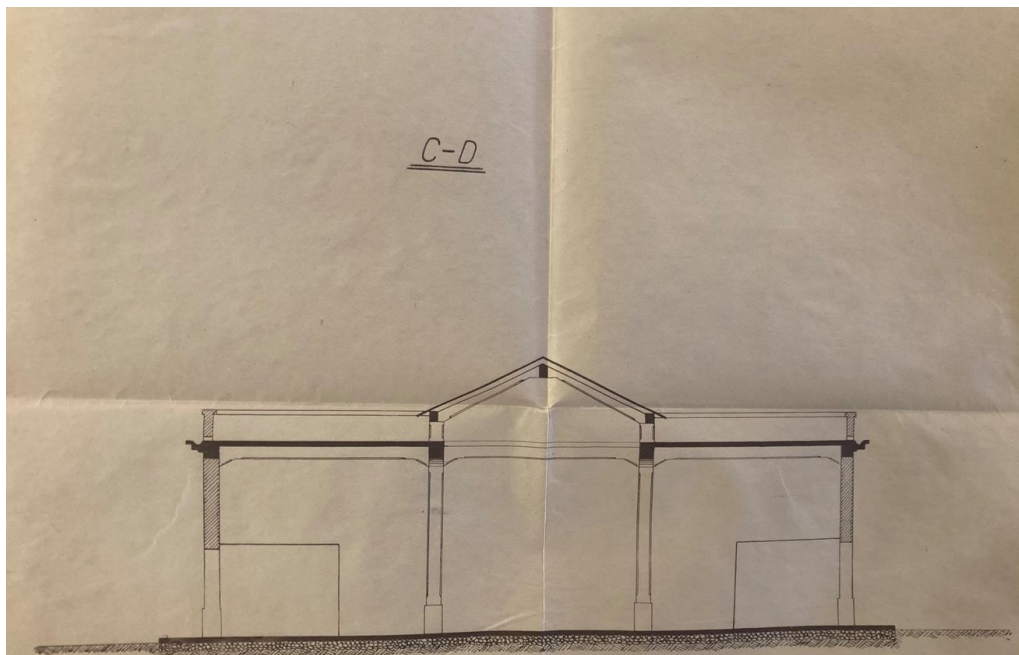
Sezione trasversale C/D dell'edificio da tavola del progetto storico presente in archivio
